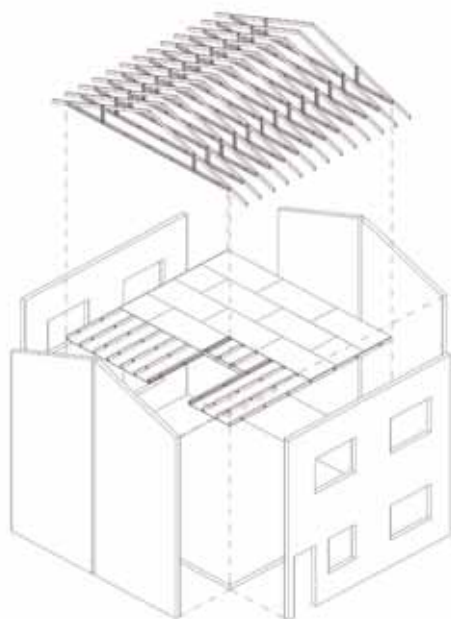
Esquema de construção tipo “balloon” (Fonte: SCI).
